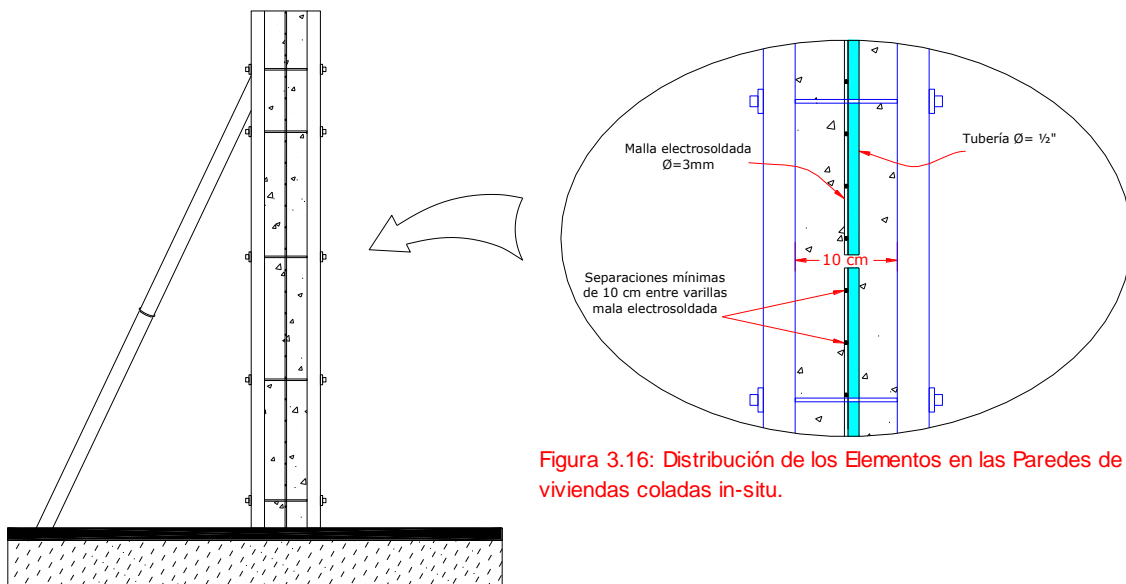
Distribución de los Elementos en las Paredes de las viviendas coladas in-situ.
